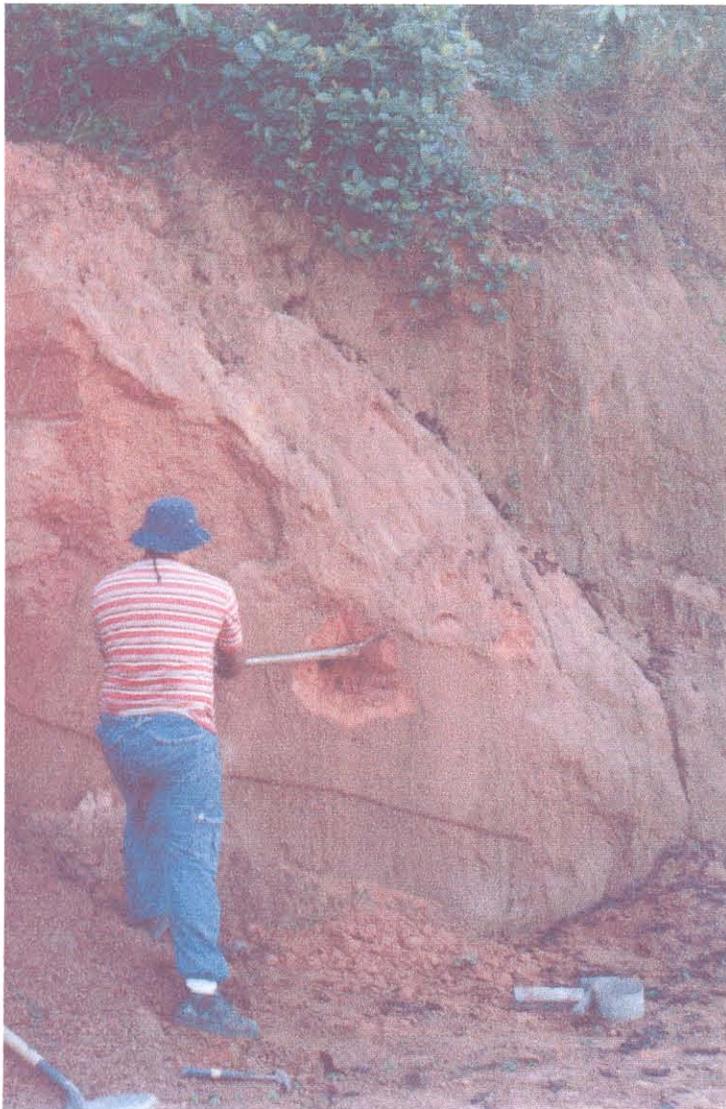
Horizonte Ferruginoso ( fácies Concrecionário), sendo preparado para amostragem com anel de parede fina, jazida de barro e piçarra da empresa Terraplena, ilha do Outeiro Ponto O5.
